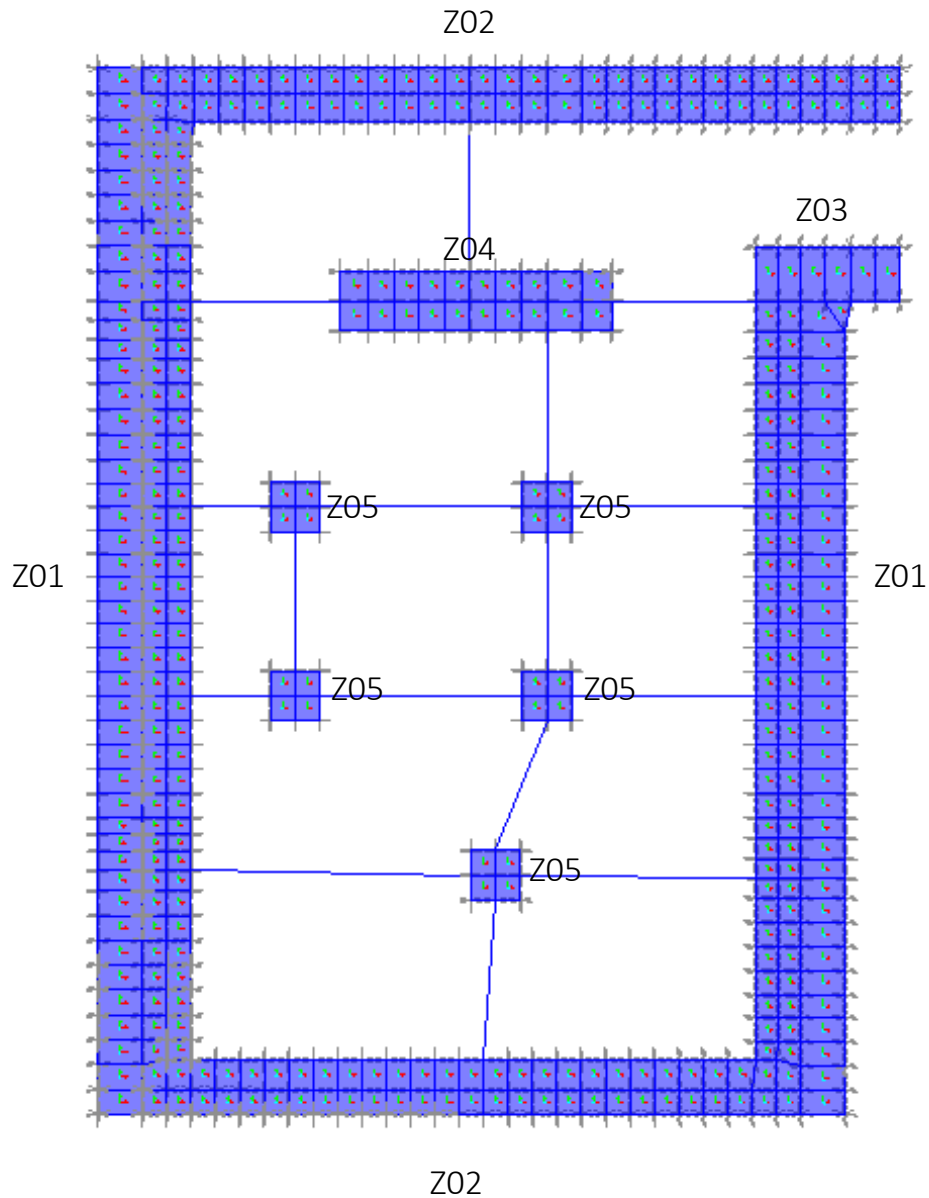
Cimentación. Fuente: elaboración propia mediante SAP2000.
